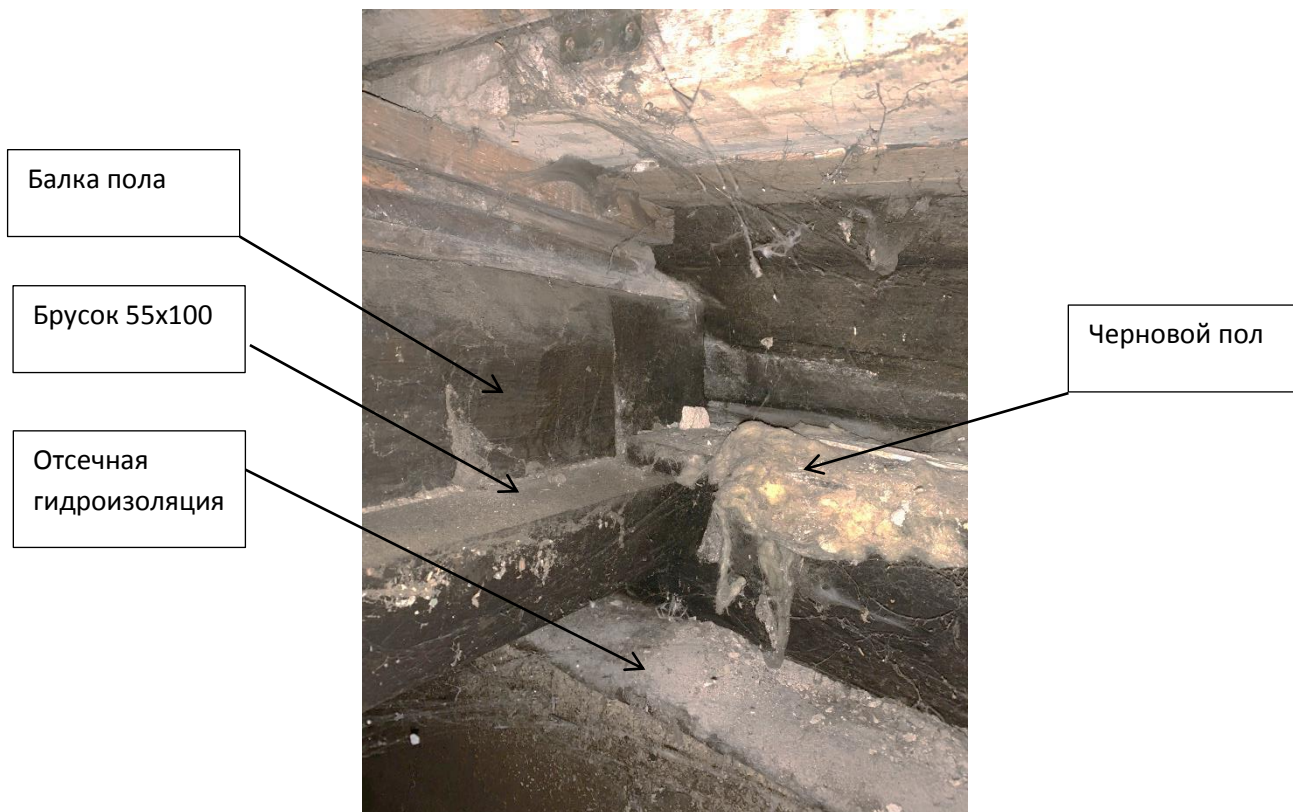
Конструкция пола в месте вскрытия №2
